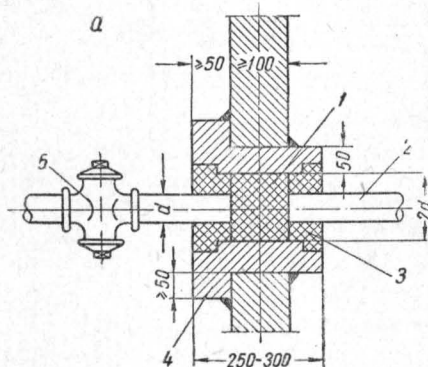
Проход трубопроводов из взрывоопасных помещений одного класса во взрывоопасные помещения другого класса (или другой среды) или в помещения невзрывоопасные или наружу через перегородки толщиной 100 мм (крепление труб около прохода см. рис. 7, В):
